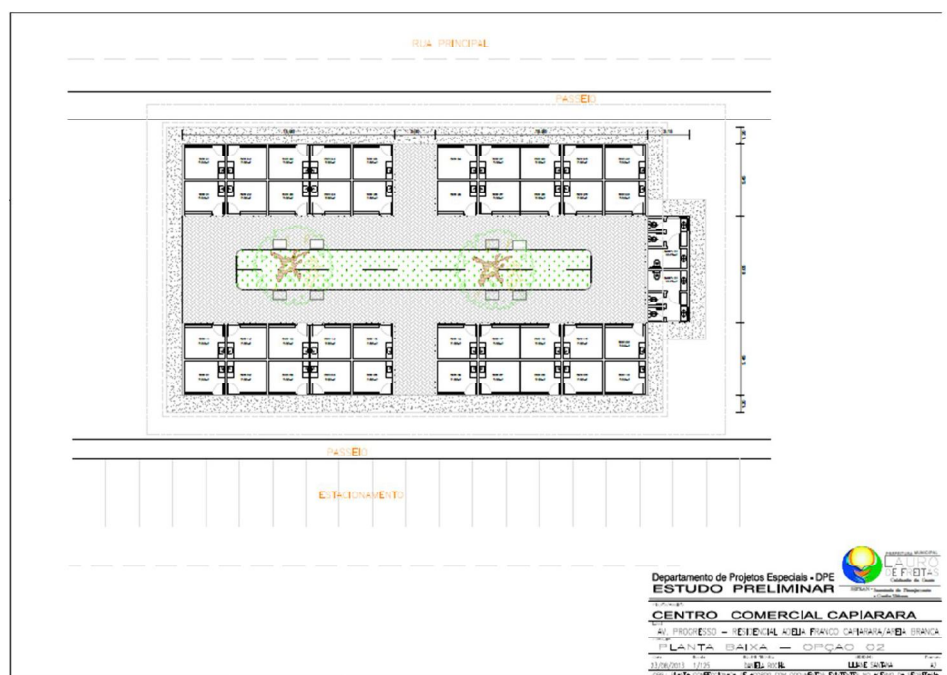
Planta baixa do Centro Comercial Capiarara – opção 2.
